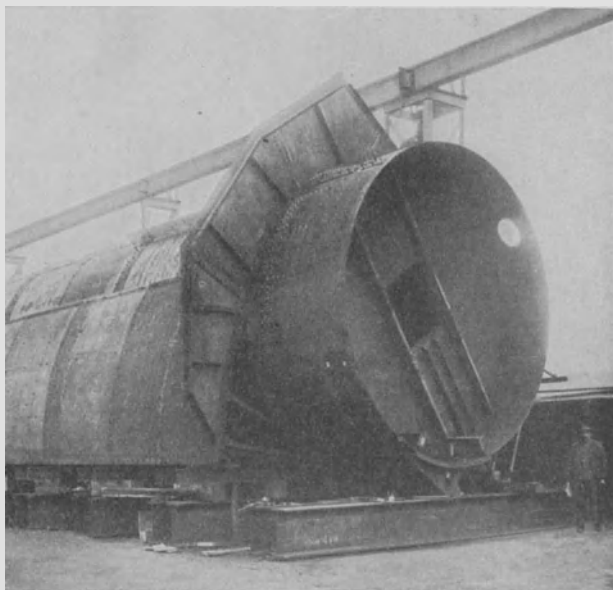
Walze der Wehranlagen Raanaasfos (Norw.) von 45 m L. W. und 6,5 m H.) in Fabrikmontage.
